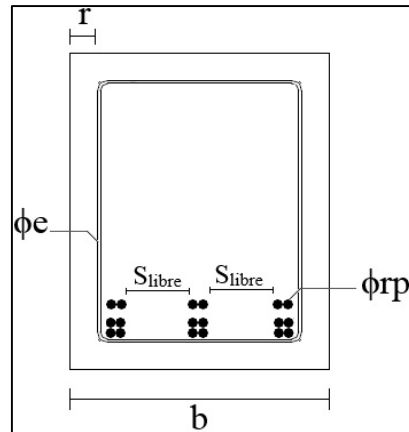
Condiciones de refuerzo tentativas en viga longitudinal.
